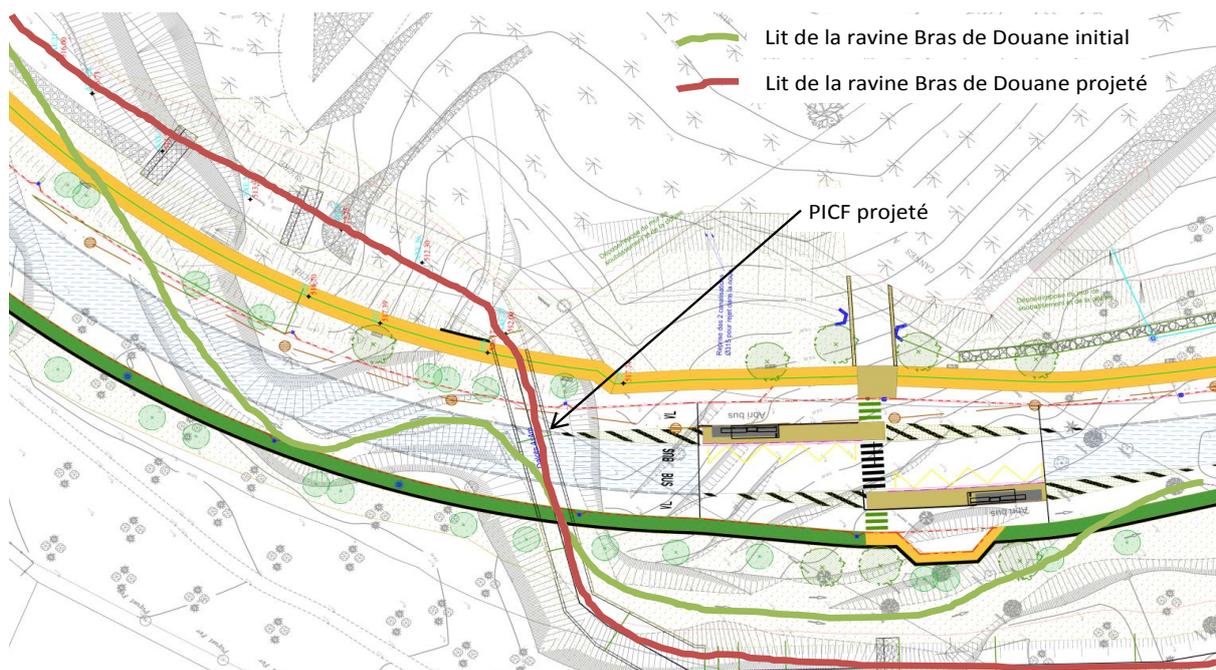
Détail du plan de masse du secteur de remblaiement de la ravine Bras de Douane de l'université
